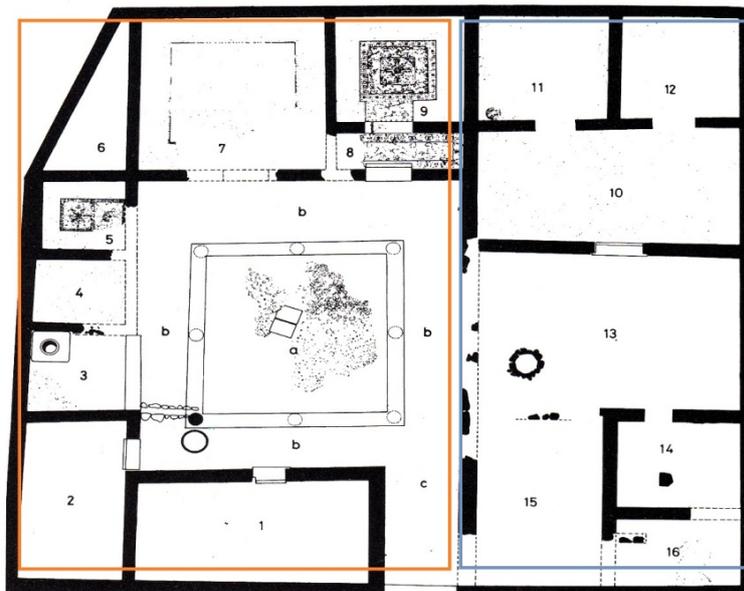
planta da casa da Erétria. (Capitel,2005)⁶⁰
